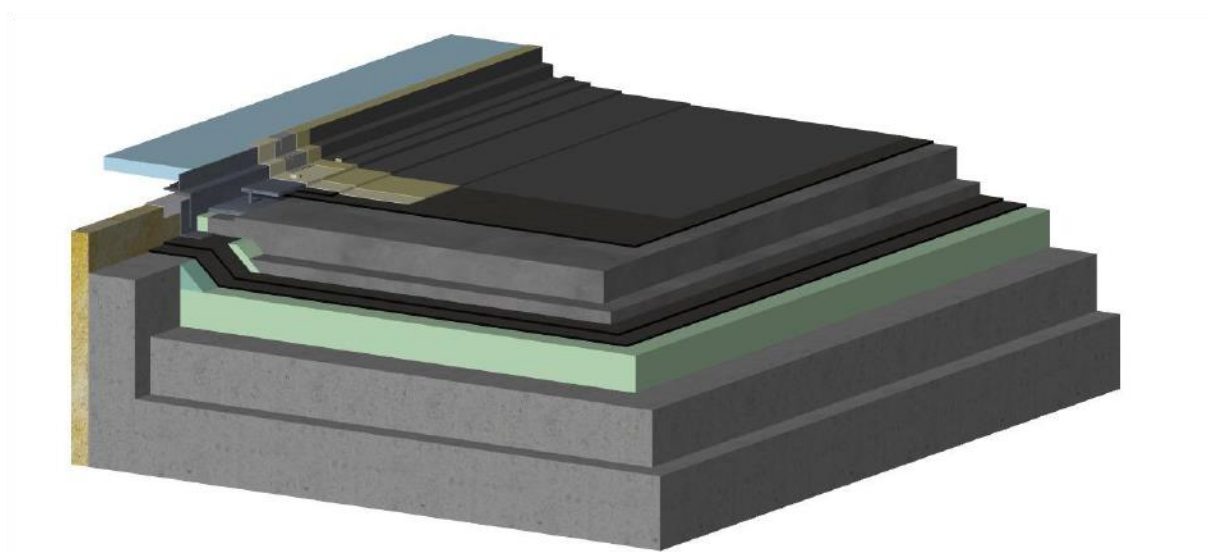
Provádění pochozí úpravy kolem světlíků
